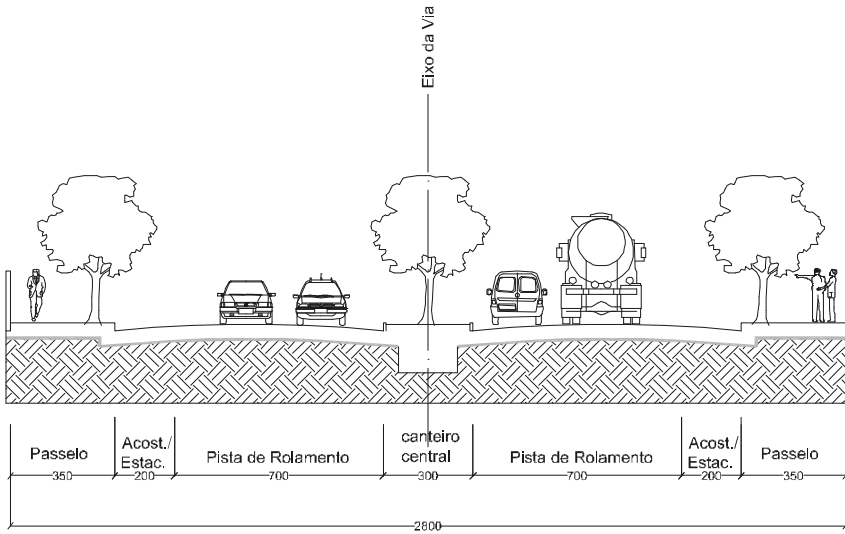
Secção Transversal SCI-5 (1): Plano para Avenida Gama D'êça. Fonte: LIMA (2005)
